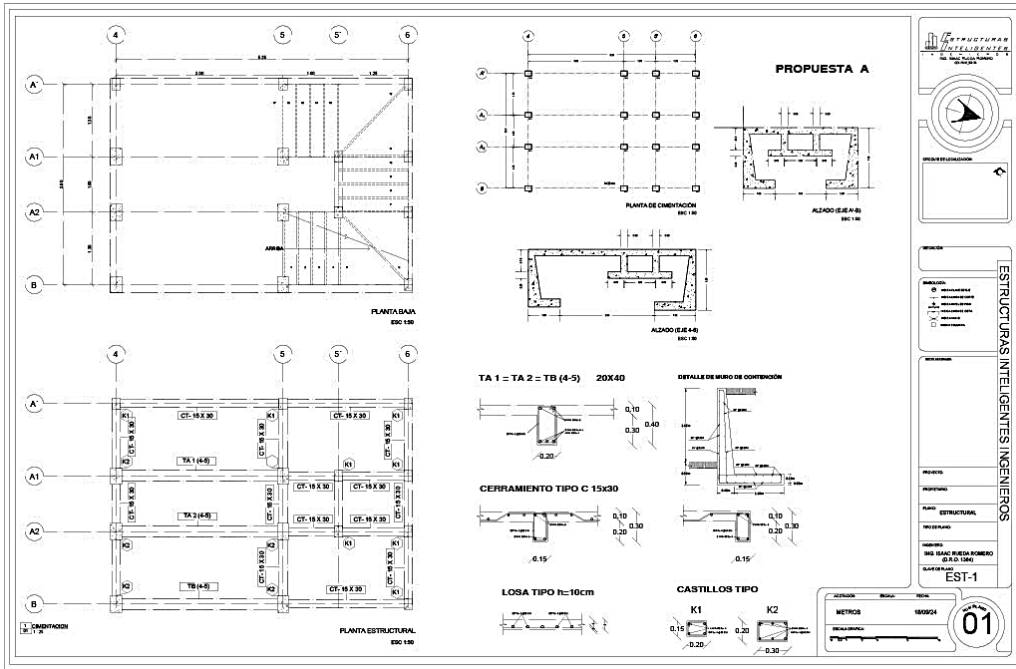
Propuesta de una escalera, cimentación y detalles estructurales.
